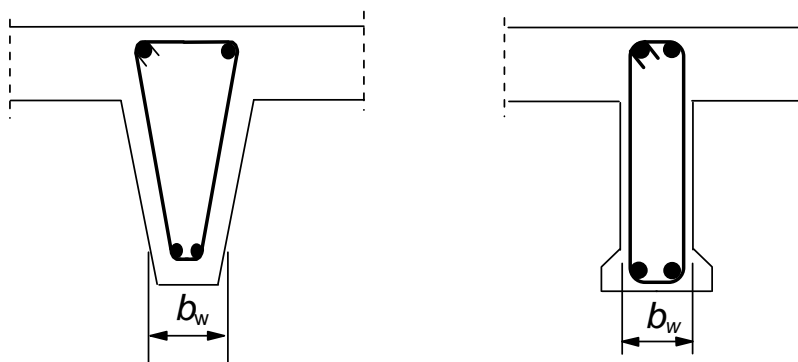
Modelo de treliça e notações para elementos com armaduras de esforço transversal
